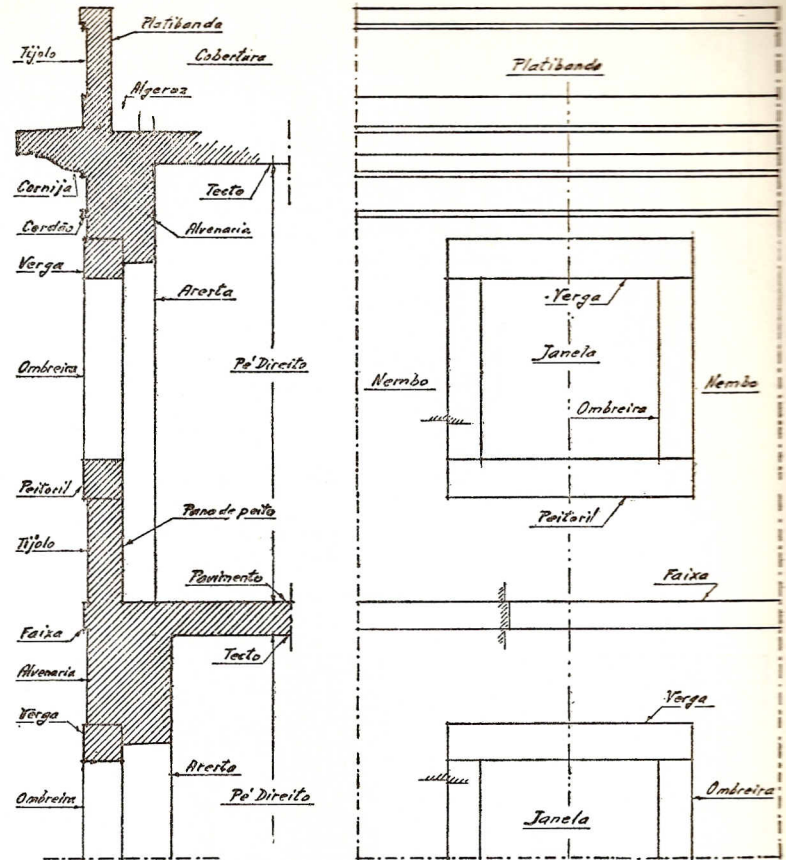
CORTE DE UMA FACHADA ATÉ À PLATIBANDA
